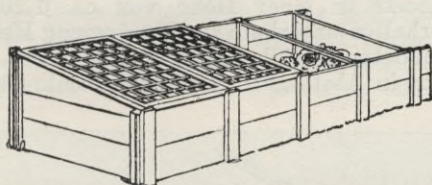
a. Frühbeetkasten aus Eisenbeton.
